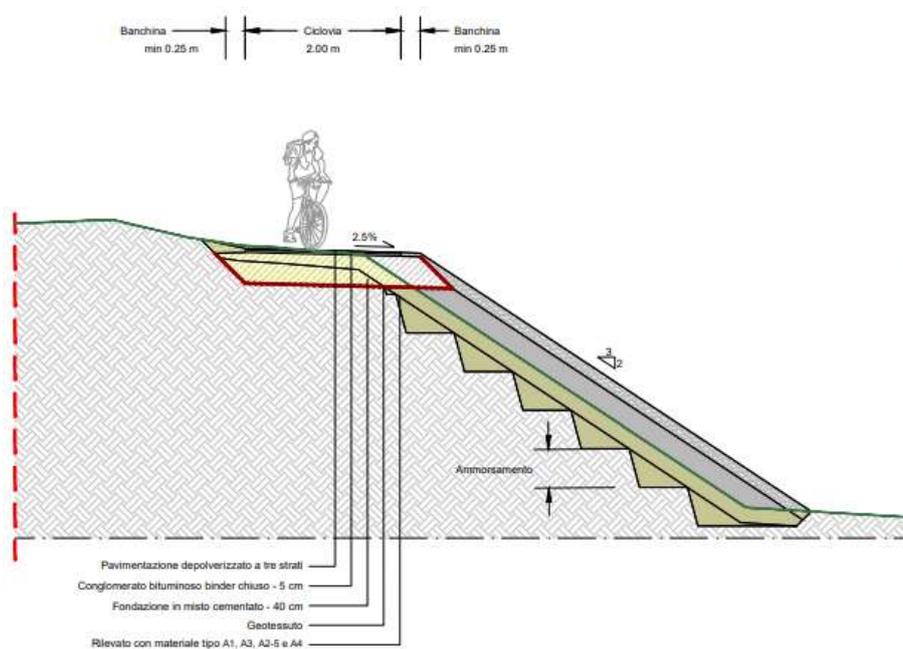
Sezione rampa risalita sul ponte , da progetto MATE
